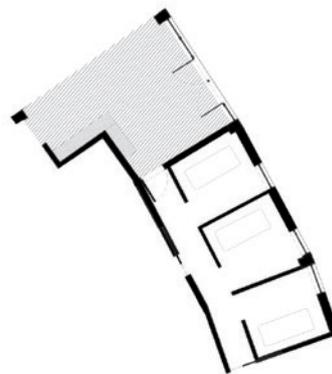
Planta Piso 1 | Salas de Tratamento | Bloco A
